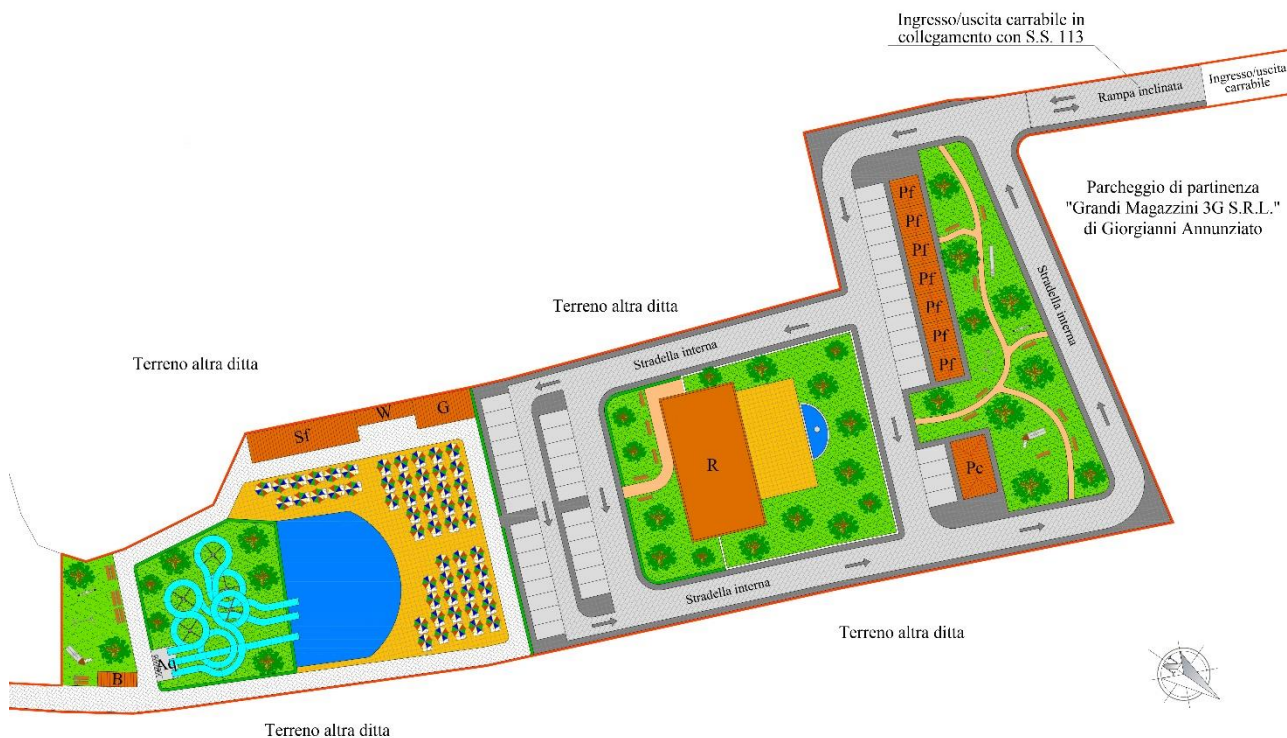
Stralcio “Tav.2 - Planimetria del lotto”
